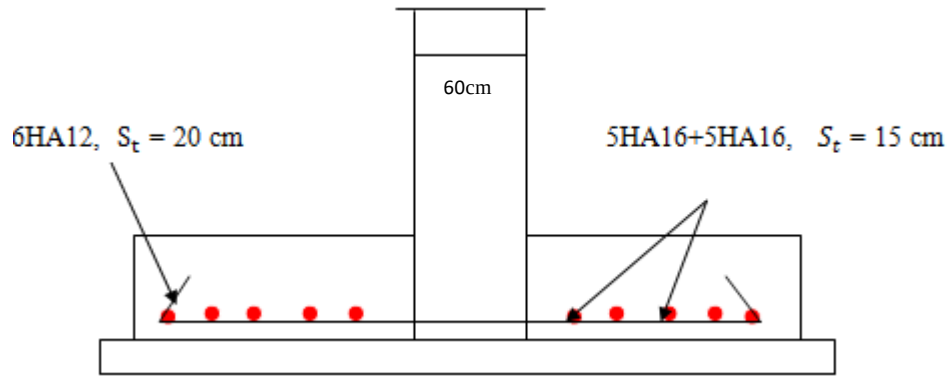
Schéma de ferrailage de la semelle filante sous poteaux.
